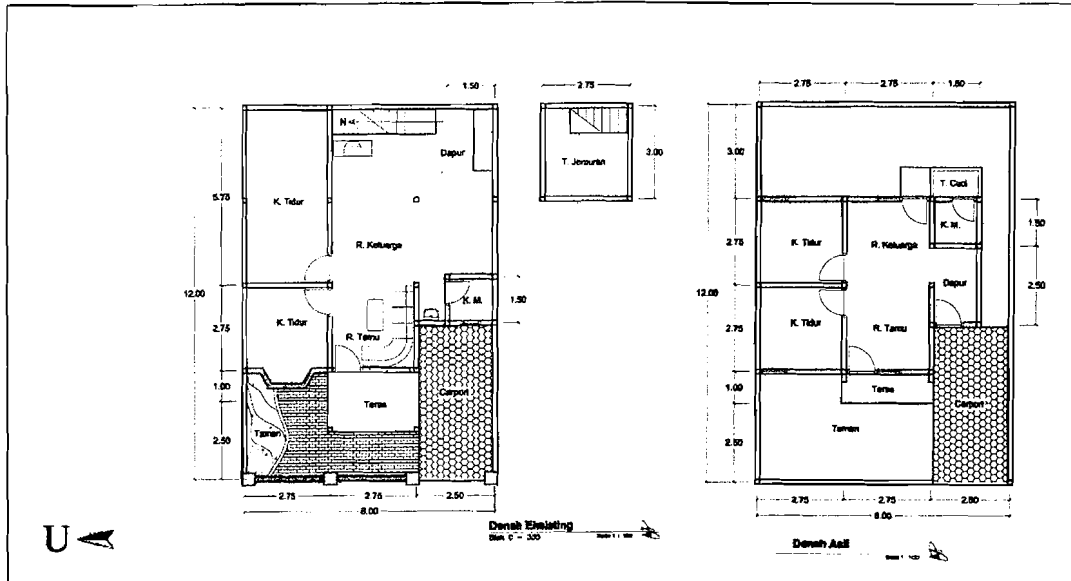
Denah Asli dan Denah Eksisting Blok C 340 yang mengalami penambahan ruang makan, ruang dapur dan pelebaran ruang garasi.
